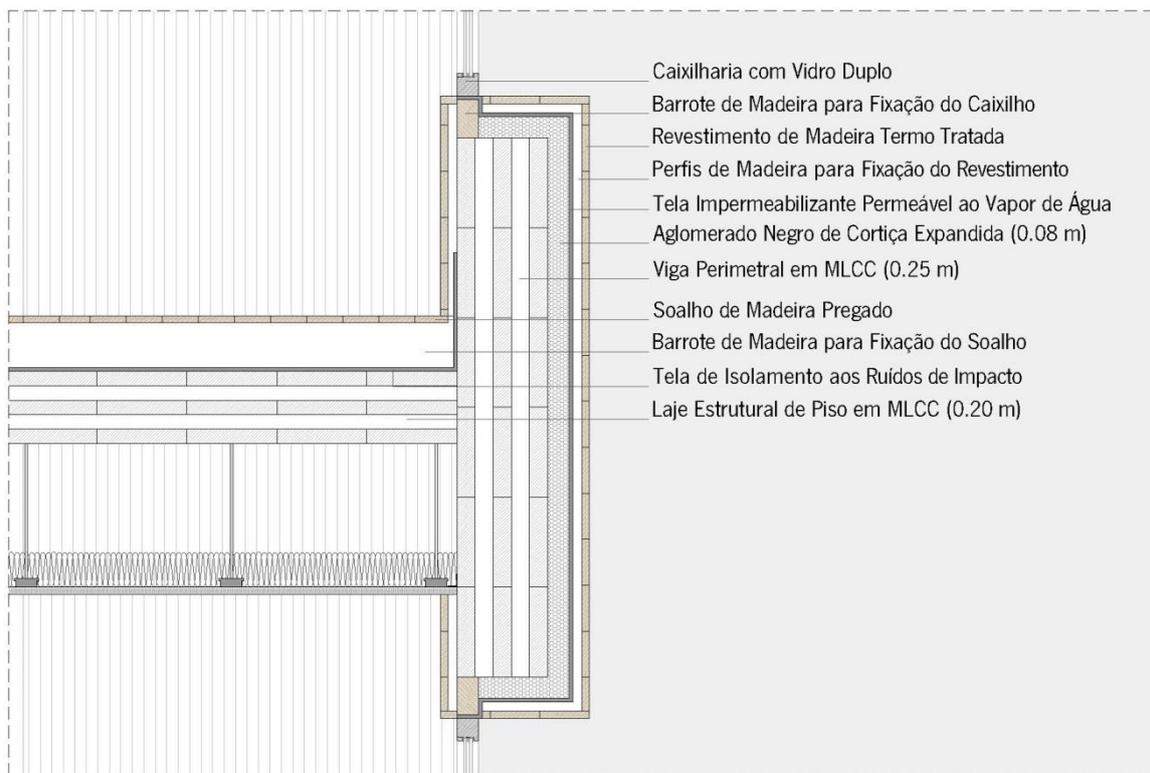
Pormenor Construtivo das Vigas Perimetrais (Esc. 1/20)
